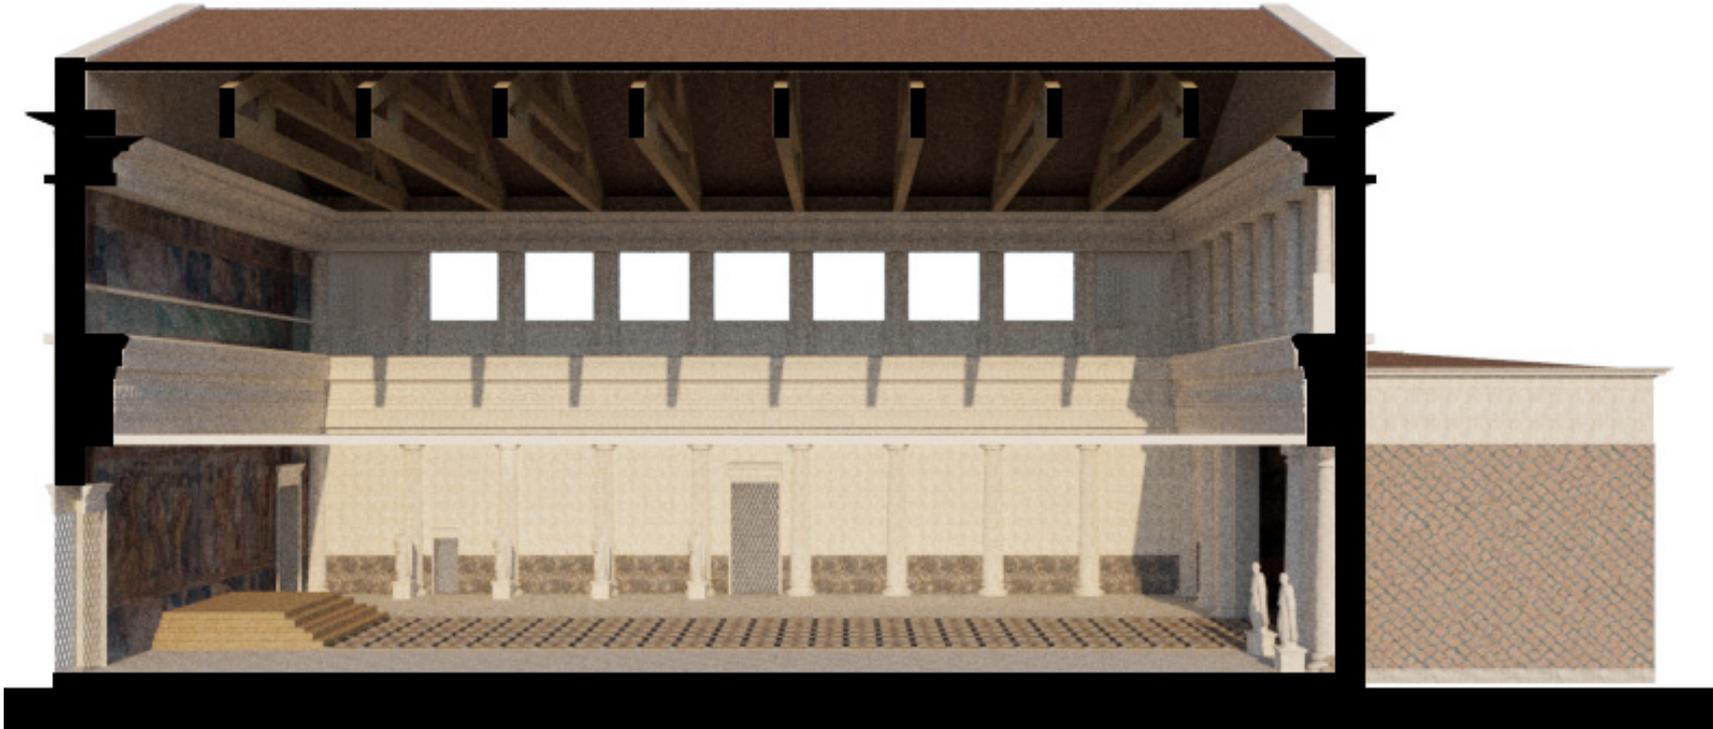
Sección transversal (Autoría propia, 2021)
